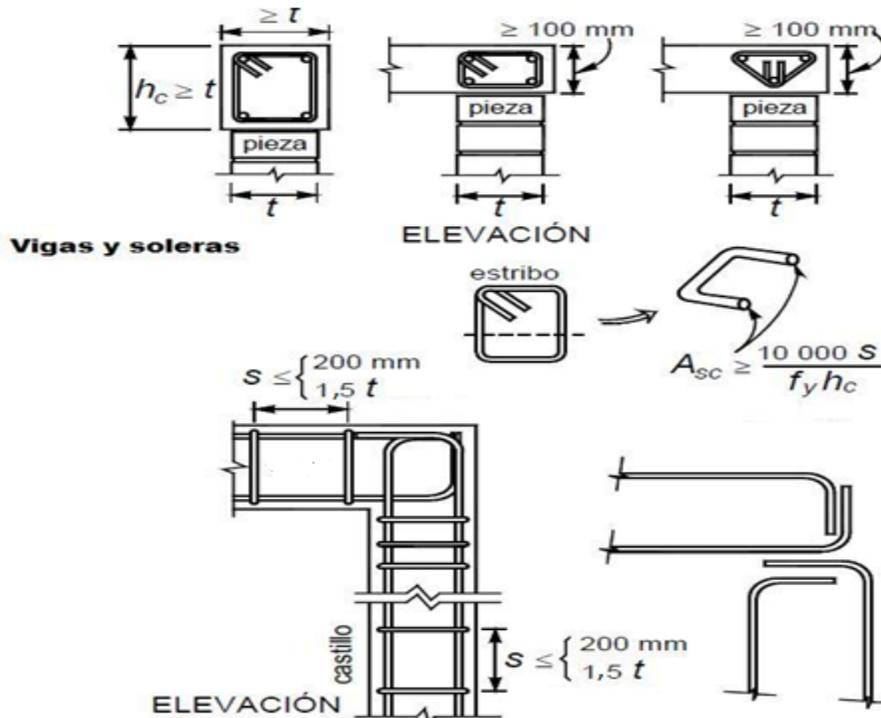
Requisitos para mampostería reforzada para vigas y soleras
